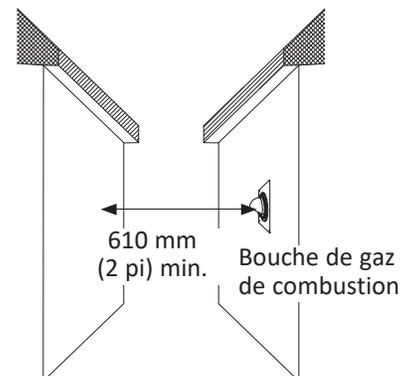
Distance minimale entre la bouche d'évacuation murale et une autre structure
